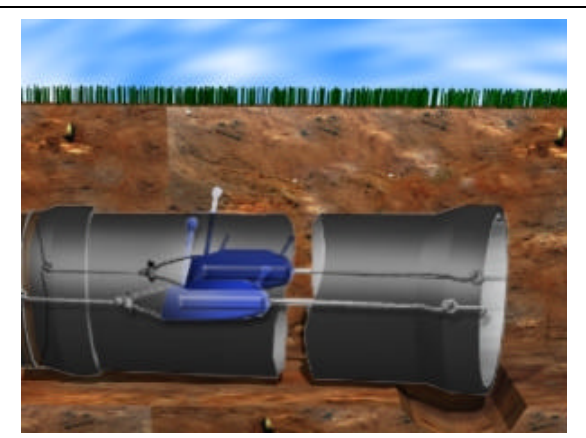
ou conjugados, talhas manuais ou macacos hidráulicos, a depender do peso da tubulação ou conexão a ser assentada.
